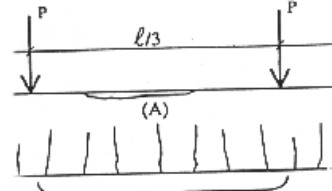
Fissuras em uma viga fletida
